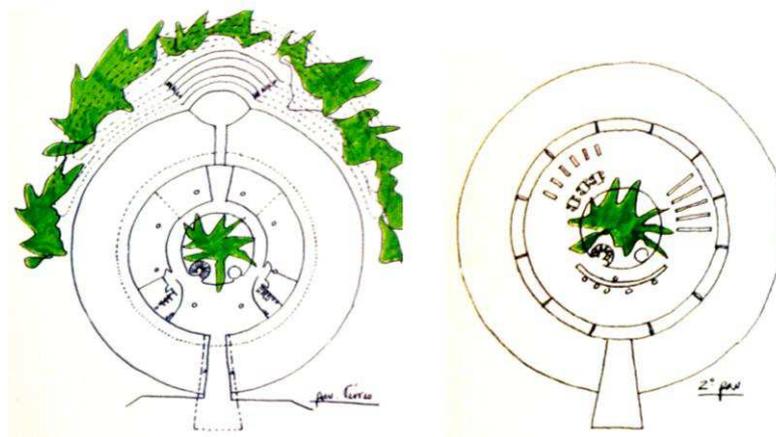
Planta Baixa - Pav. Térreo e Segundo pavimento.
